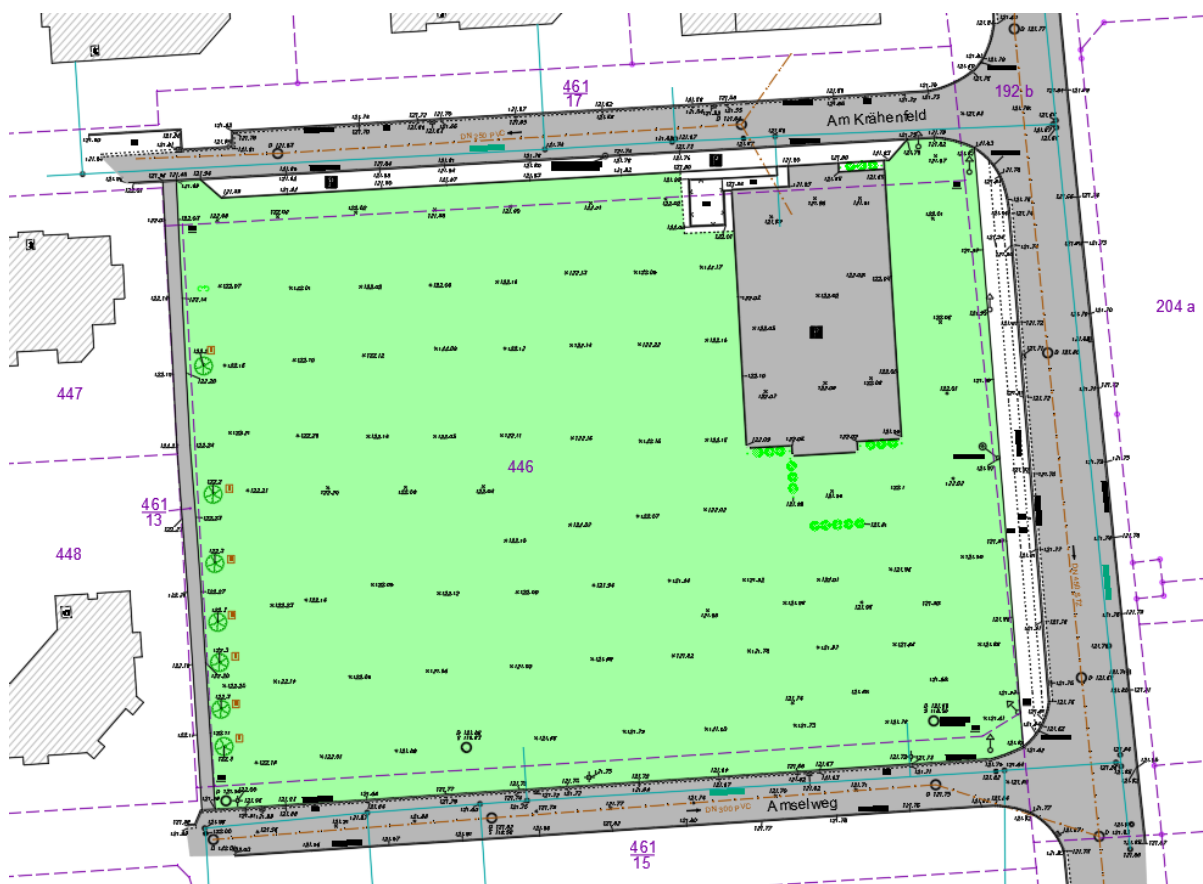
Bestandsplan des Plangebietes (Stand Mai 2017)
